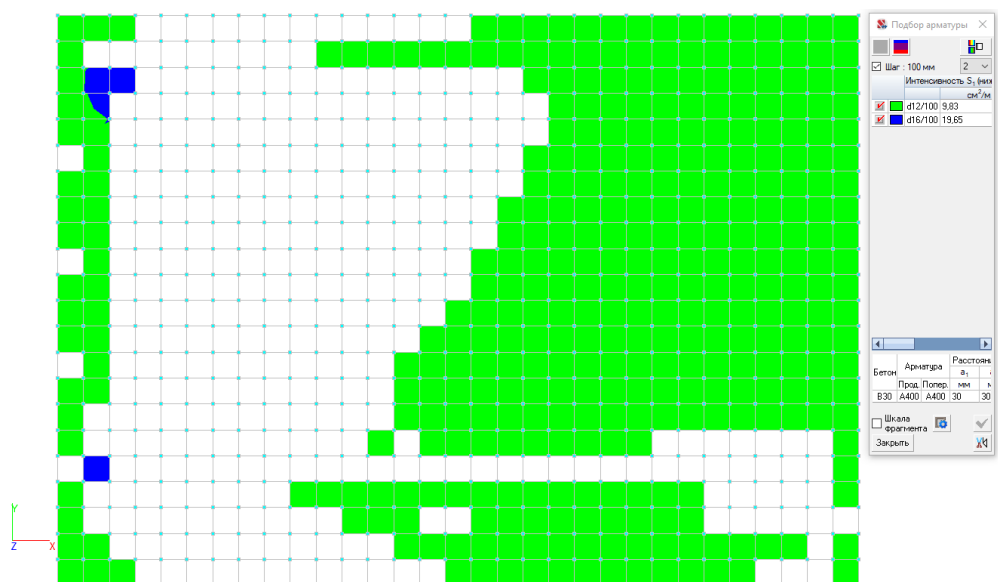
Интенсивность армирования нижнего пояса плиты перекрытия по оси OX
